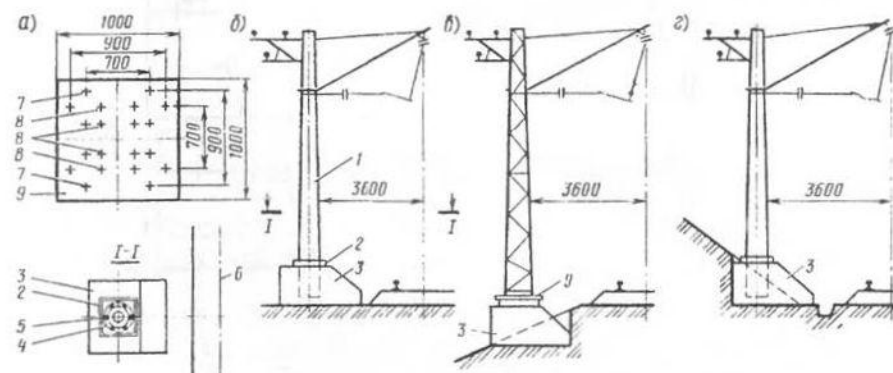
Схемы переходной плиты (а), установки фундаментов и опор на площадке (б), насыпи (в), в выемке (г):
